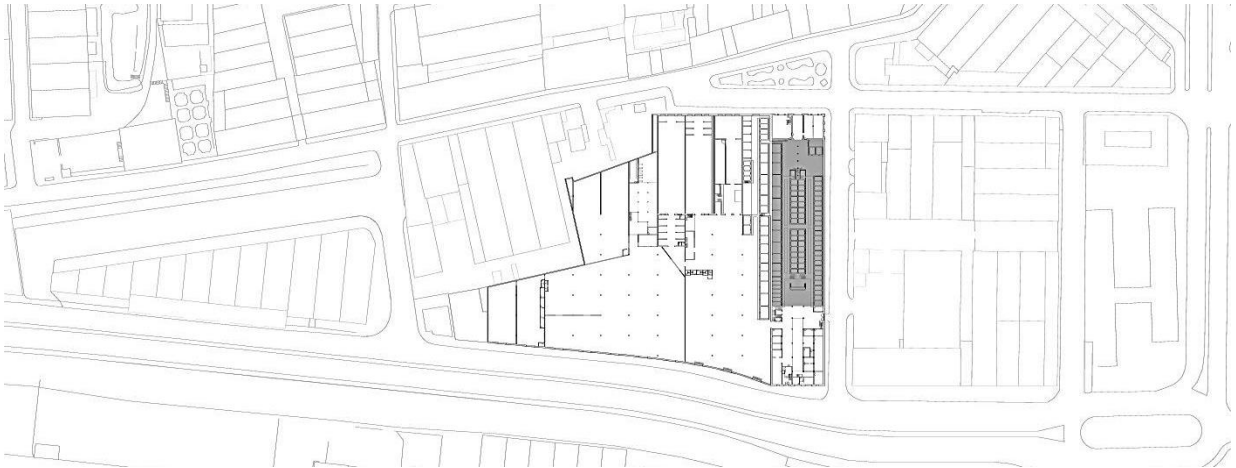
Planta de levantamento fotográfico piso térreo – Armazém 2.
